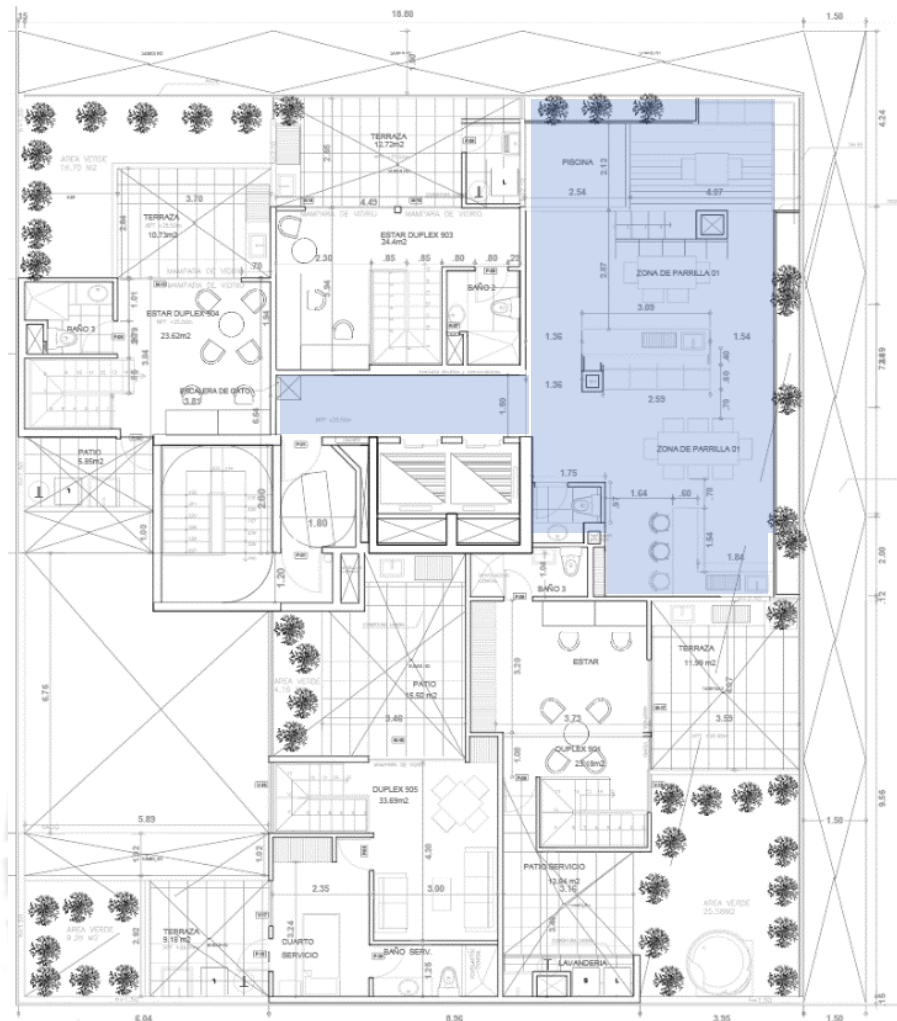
Planta Azotea proyecto QIU. Fuente: Plano editado de EE inmobiliaria
